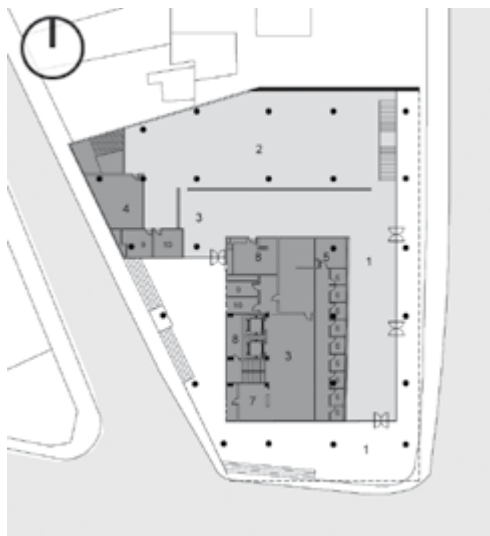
Planta primer piso, edificio Miguel de Aguinaga
